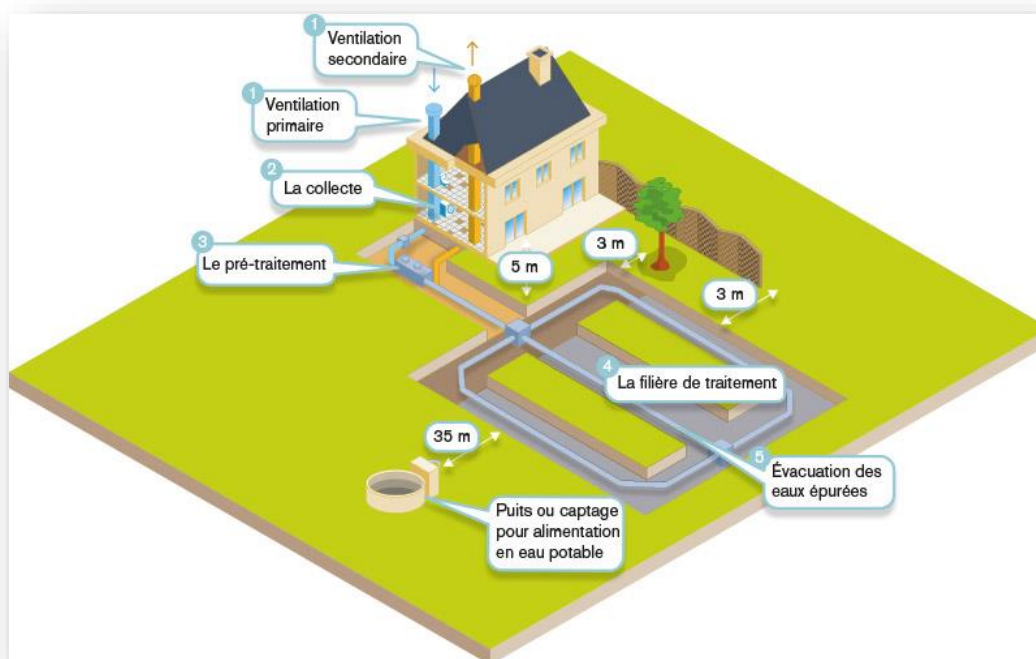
Schéma type d'une filière d'assainissement non collectif
